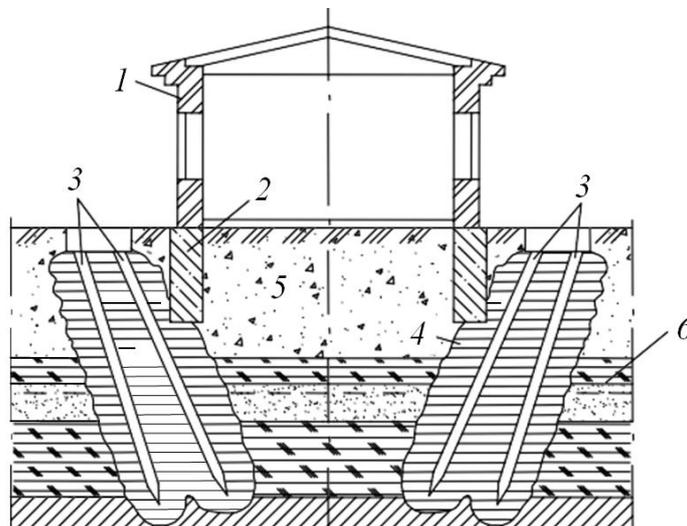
Вариант упрочнения основания песчаными сваями: 1 – здание; 2 – фундамент; 3 – песчаные сваи; 4 – зона упрочнения; 5 – насыпной грунт; 6 – торф
